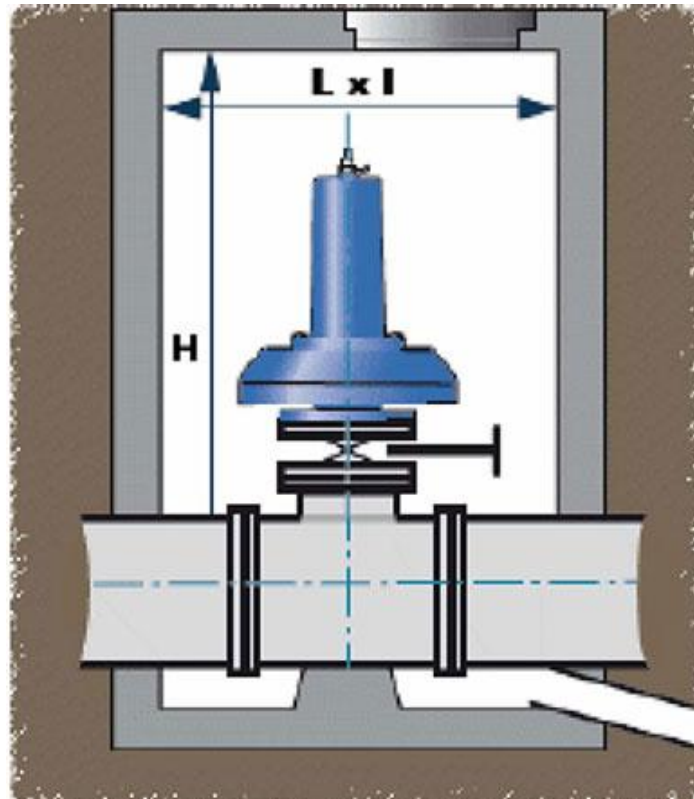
installation de soupape sur la conduite (catalogue d'entreprise PAMLINÉ)
